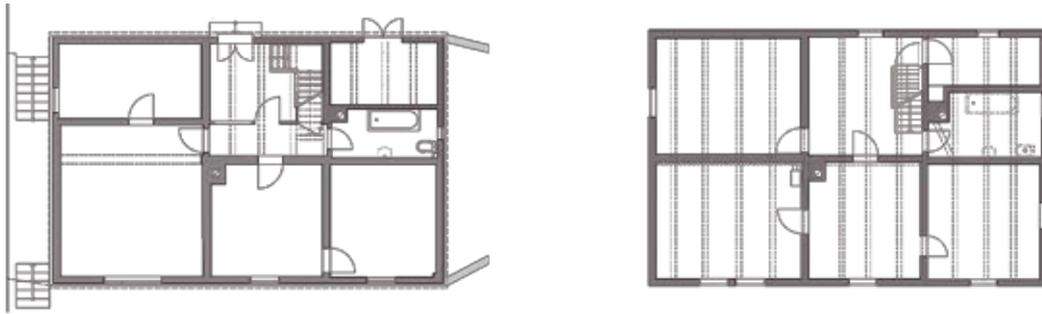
Grundrisse EG (links), OG (rechts) M 1:500, Küsterhaus Elbenberg
